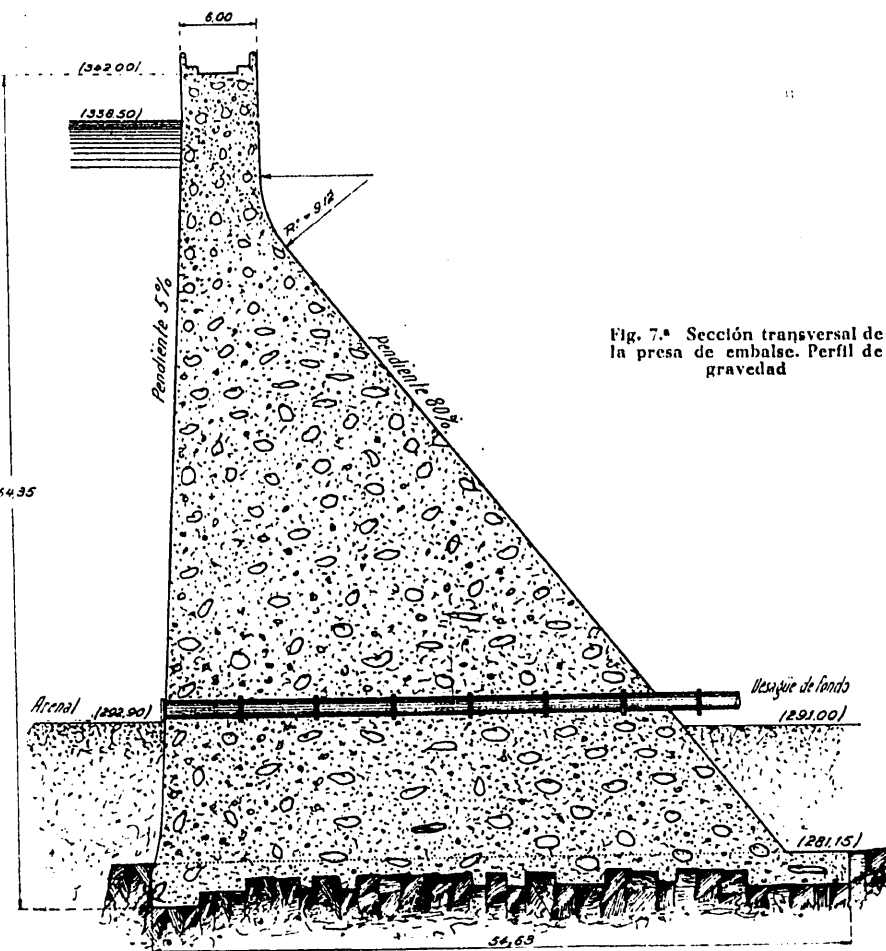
ª Sección transversal de la presa de embalse. Perfil de gravedad
